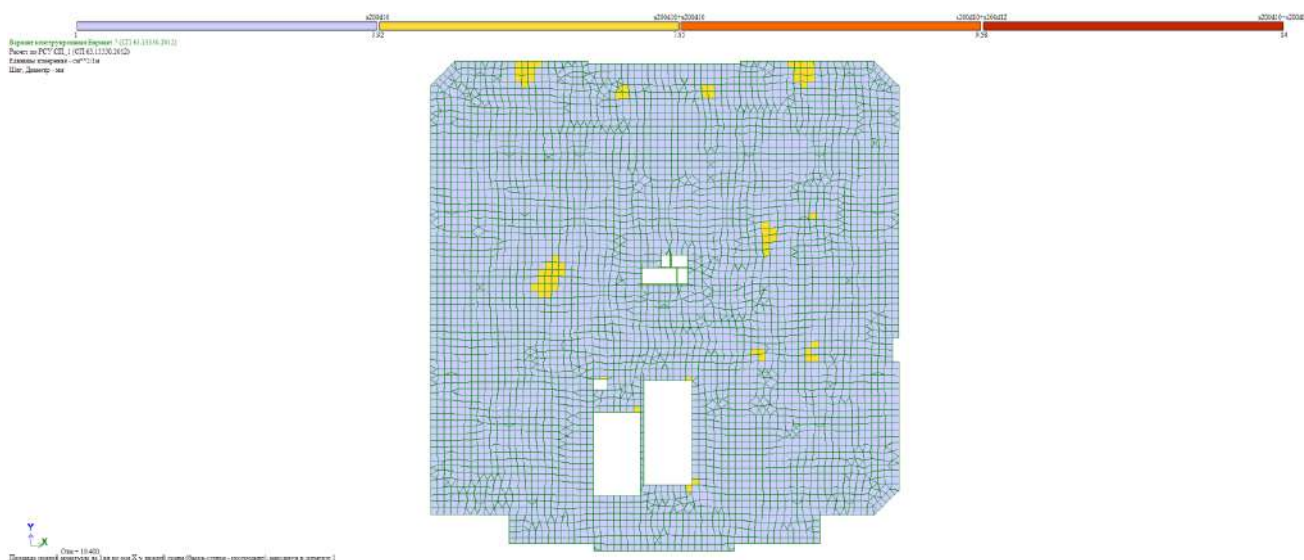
Мозаика армирования нижней арматуры вдоль б.о
